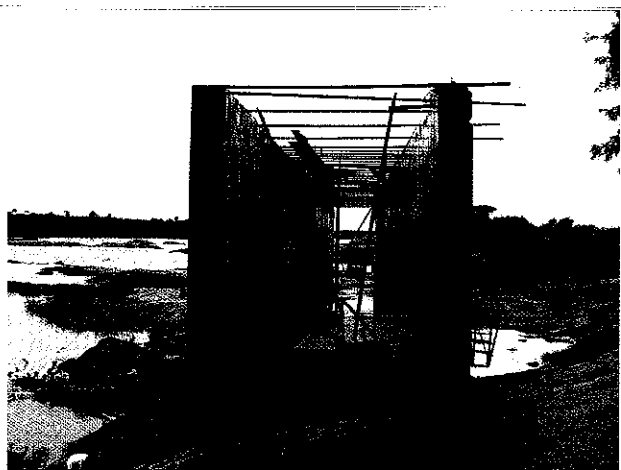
A estrutura é feita de concreto e foi construída na Área de Preservação Permanente.
